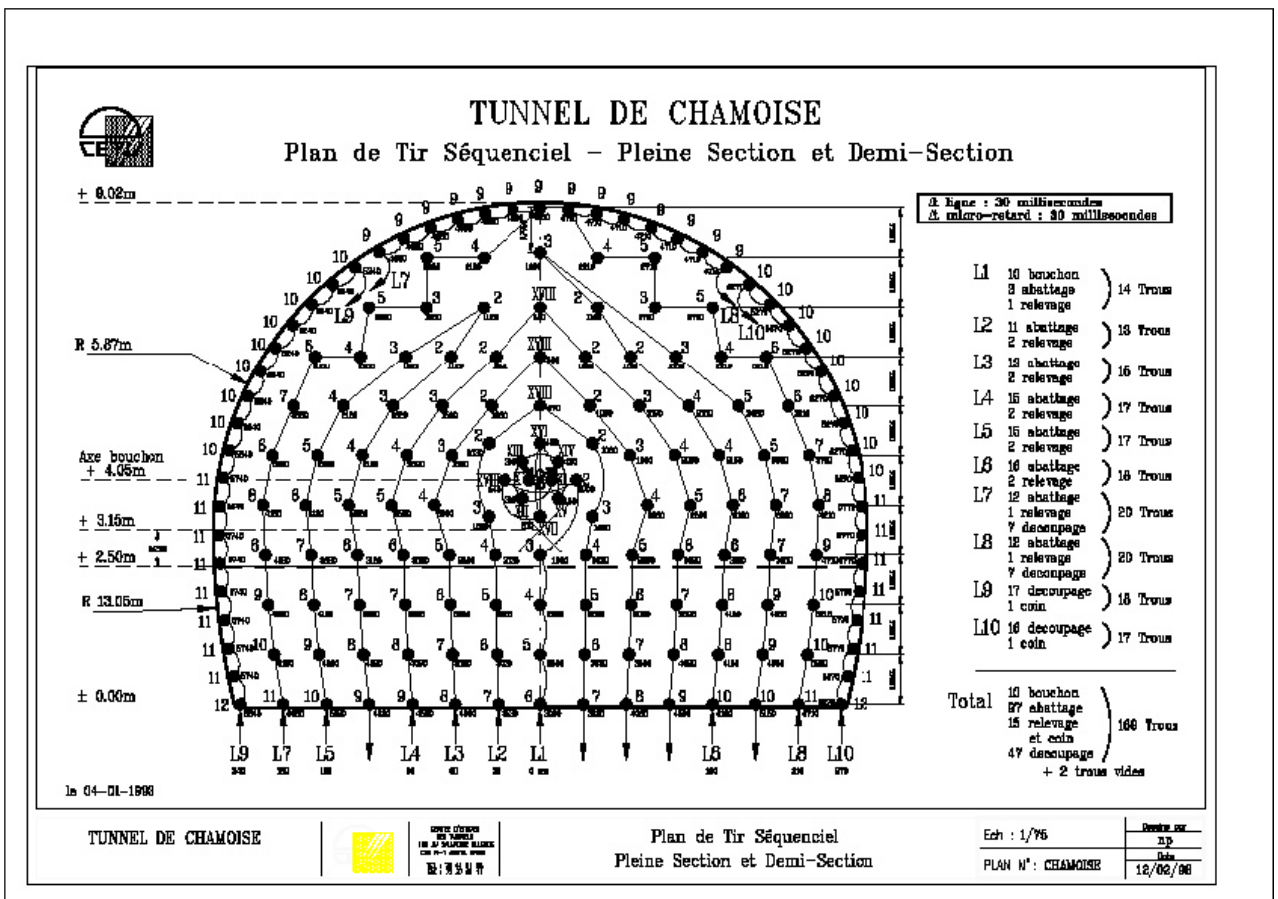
Figure C: Plan de tir ; coupe transversale d'un tunnel front de taille.
